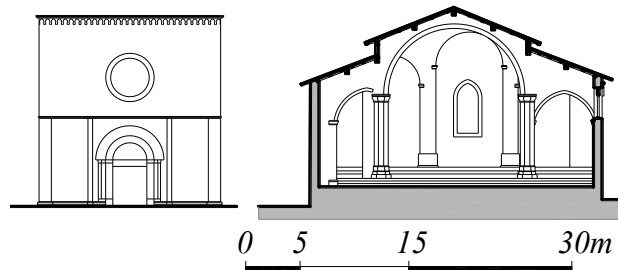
Chiesa di S. Pietro di Coppito: Prospetto facciata e sezione trasversale in corrispondenza dell'arco trionfale
